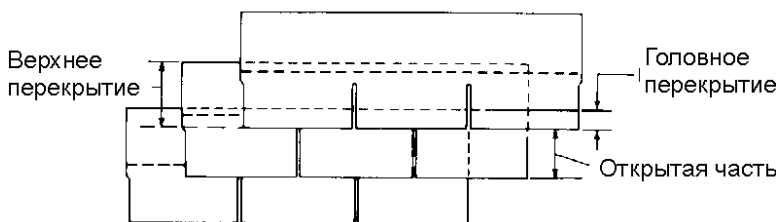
Головное и верхнее перекрытие (Bird and Son)
